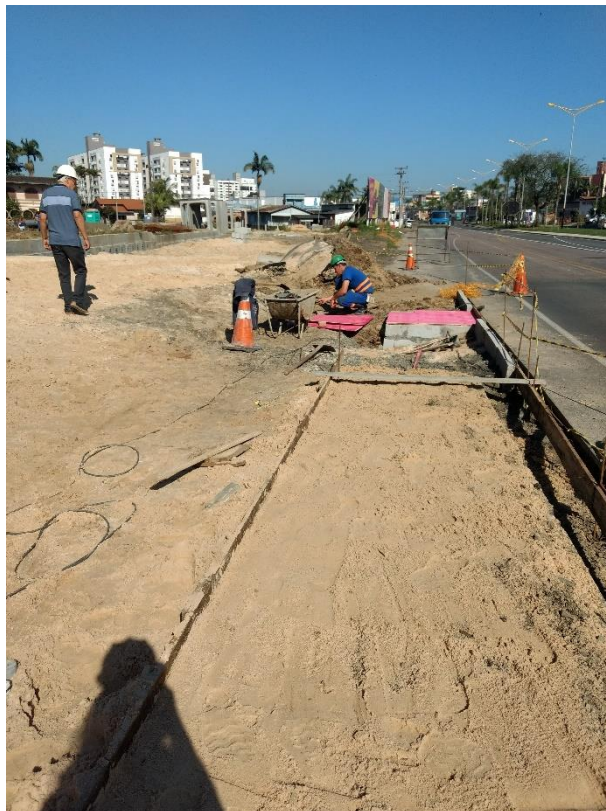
Construção da calçada e bueiro. (Fonte: Dos Autores 2018)
